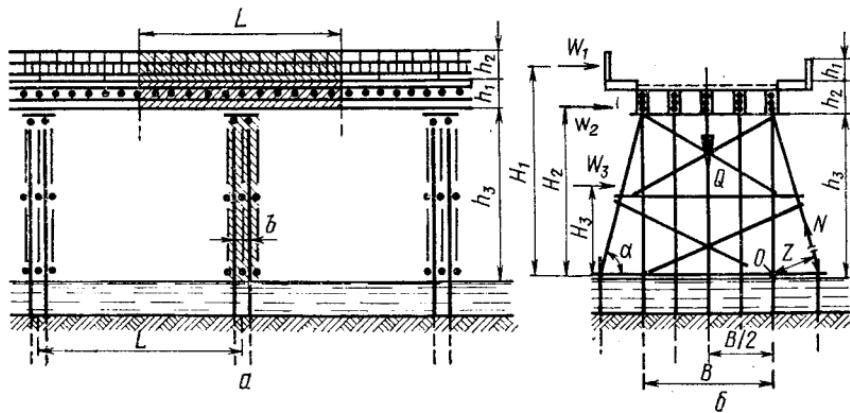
Схемы к расчету свайной опоры на действие ветровой нагрузки:
